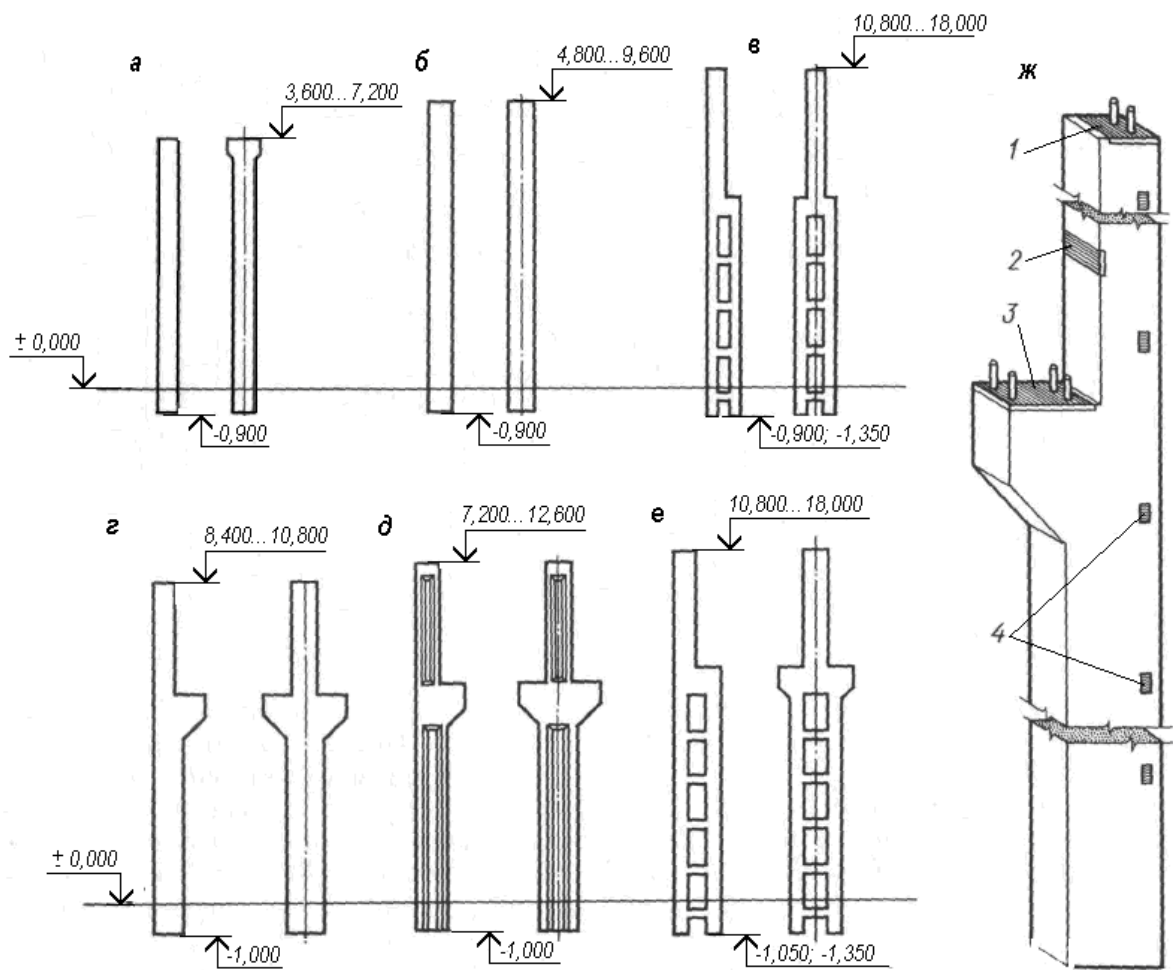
Основні типи залізобетонних колон одноповерхових виробничих будівель: а – прямокутного перерізу для будівель без мостових кранів при кроці колон 6 м; б – те ж при кроці 12 м, в – двогілкові для будівель без мостових кранів, г – прямокутного перерізу для будівель з мостовими кранами, д – те ж, двотаврового перерізу, е – двогілкові для будівель з мостовими кранами, ж – загальний вид колони, 1 – закладна деталь для кріплення несучої конструкції покриття, 2 – те ж, підкранової балки, 3 – опорний лист для кріплення підкранової балки; 4 – закладна деталь для кріплення стінових панелей
